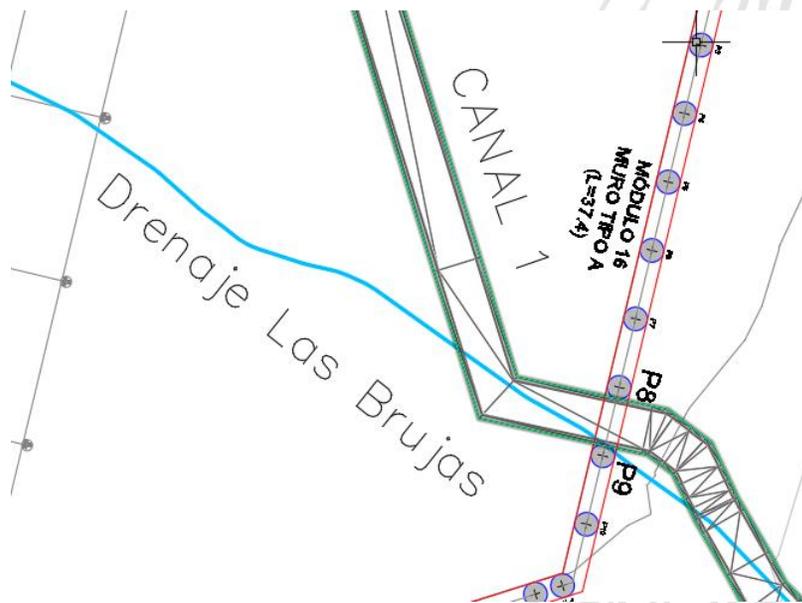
Vista en planta cruce de Canal 1 con muro de contención.
